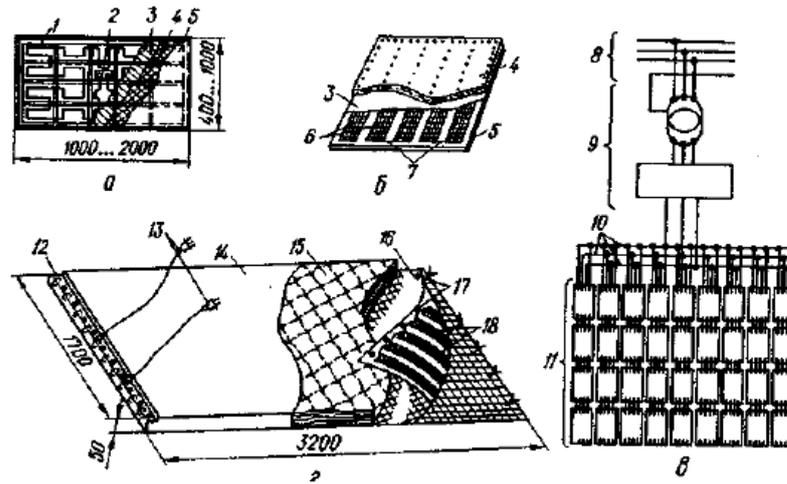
Конструкції термоопалубки і термоактивного гнучкого покриття: а – панель опалубки з нагрівальним кабелем; б – те саме, із сітчастим нагрівачем; в – схема розташування панелей; г – термоактивний мат; 1 – кабель; 2 – клемна колодка; 3 – листи азбесту; 4 – мінеральна вата; 5 – лист фанери; 6 – сітчасті нагрівачі; 7 – розвідні шини; 8 – електромережа з напругою 380 В; 9 – знижувальний трансформатор; 10 – шини; 11 – нагрівальні елементи; 12 – притискні планки; 13 – рознімання; 14 – захисний чохол; 15 – теплоізоляція; 16 – склотканина; 17 – отвори для кріплення теплоізоляції; 18 – вуглецеві стрічкові нагрівачі
